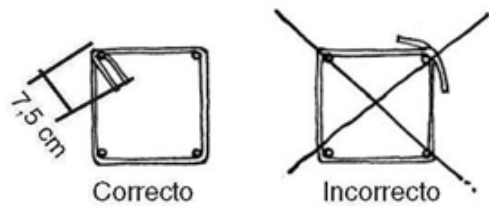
Detalle ganchos de un estribo (Totten, 2010)
